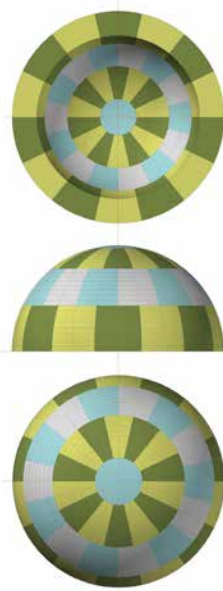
Planta, alzado y planta cenital. (Elaboración propia)
